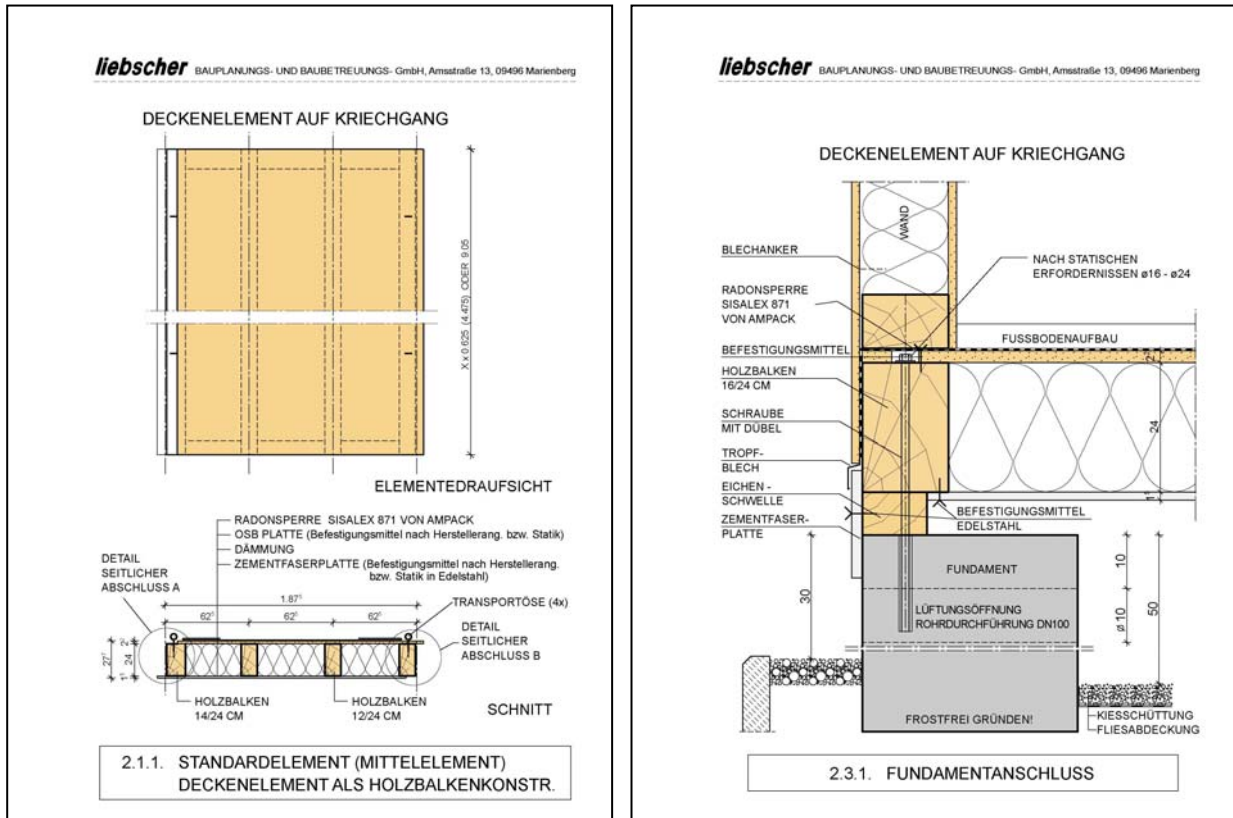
Standardelement, Deckenelement als Holzbalckenkonstruktion
